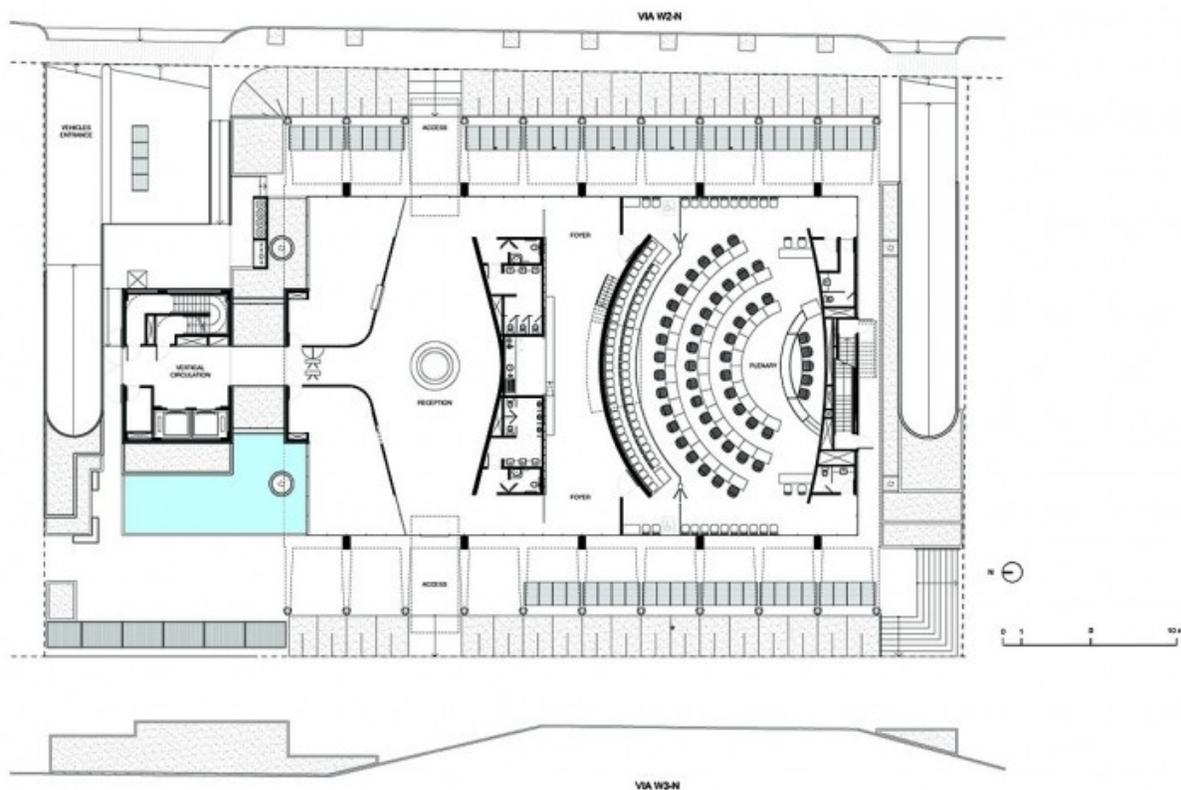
Sede do Confea: planta do pavimento térreo. Fonte: Sayegh 2011
